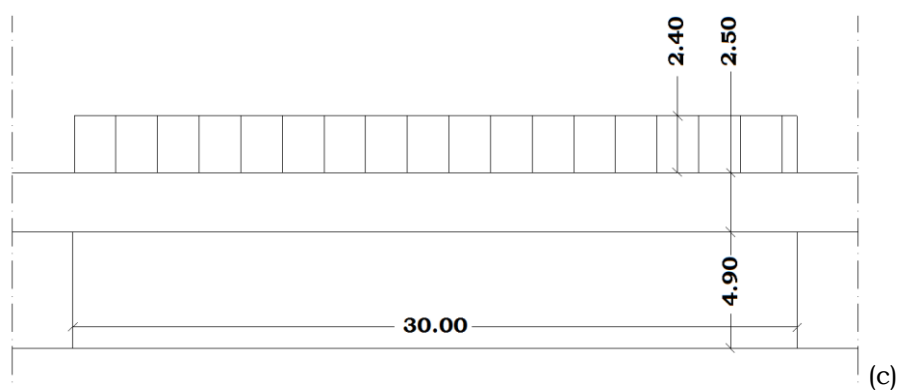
Crollo del ponte stradale - attraversamento BA01900200SP - Cassano delle Murge (BA)
